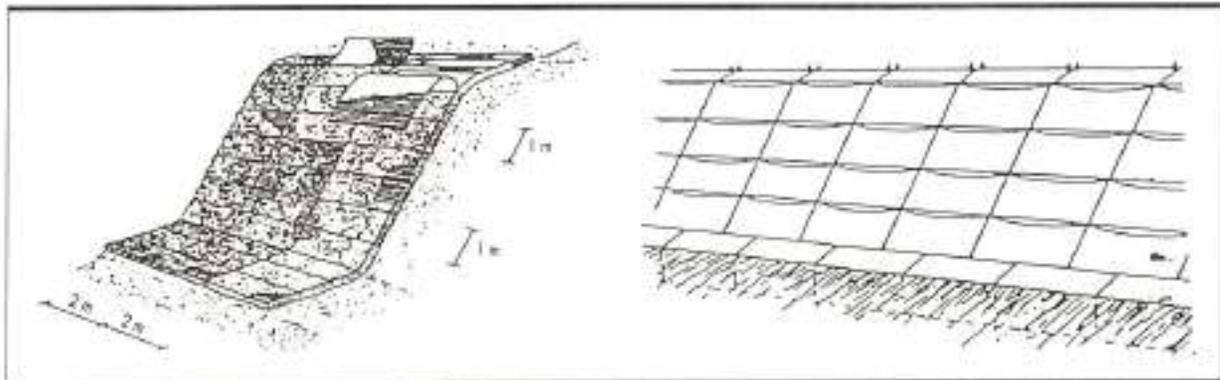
Gaviones planos y corozas en protección de márgenes.
